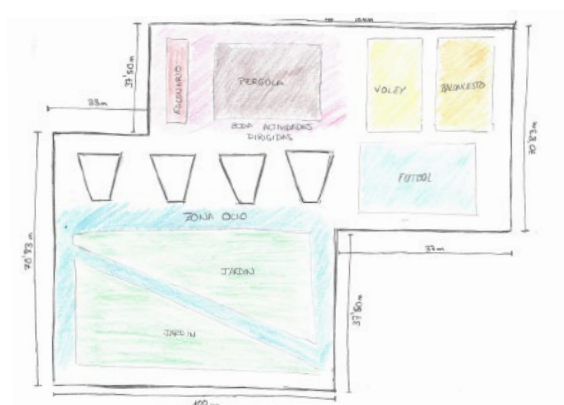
Boceto 2 de la planta de la Plaza de las Ingenierías y alrededores
